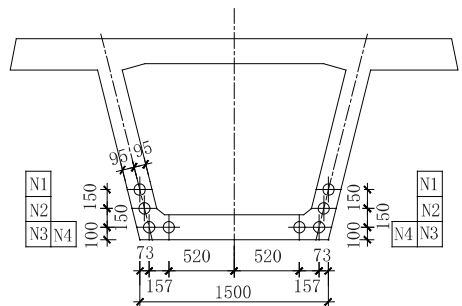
小箱梁纵向钢束跨中断面示意图(单位:mm)
